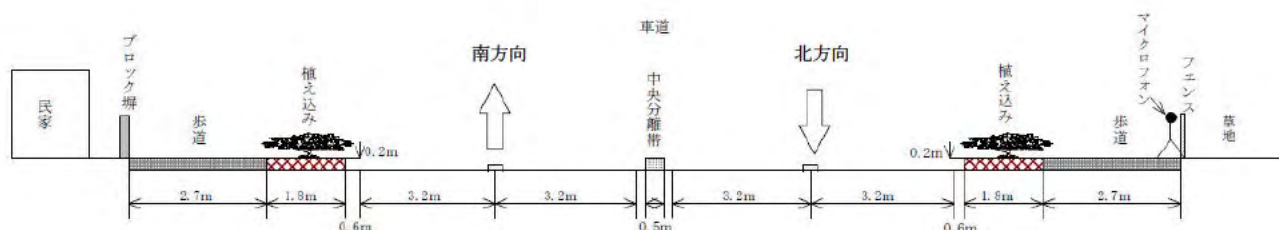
st. 2'の詳細図及び道路断面図
